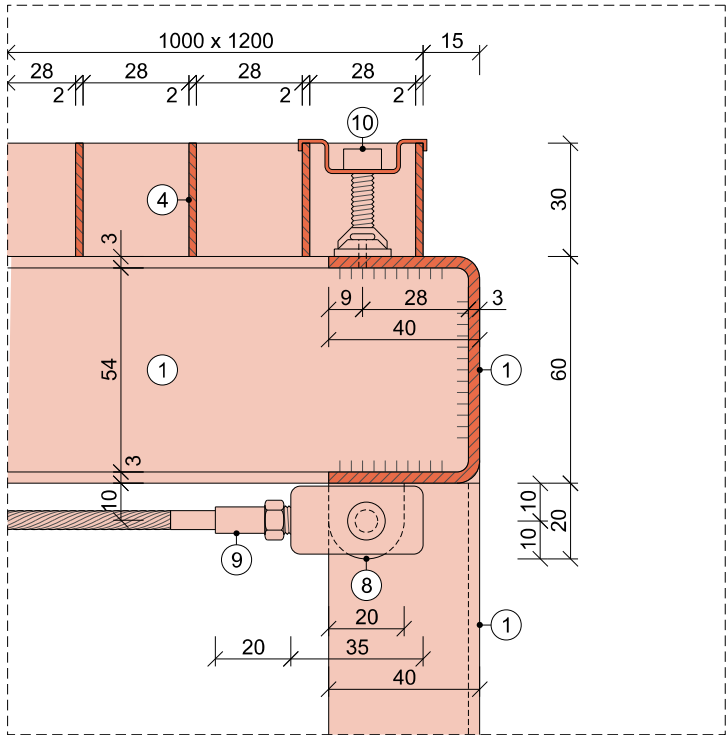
REKTIKAFKÁ NOHA S PÁTKOU (REZ)
